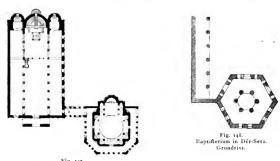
Bafilika und Baptifterium auf Torcello. Grundriss.
